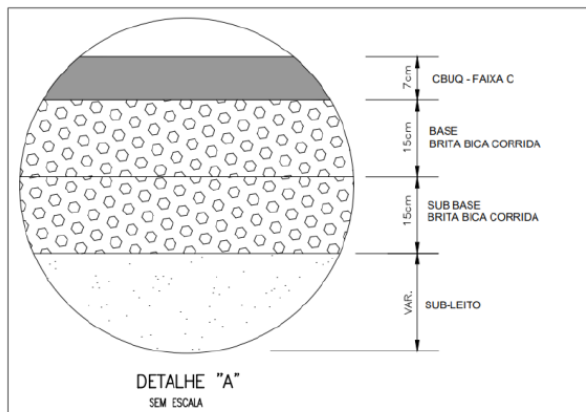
Detalhamento da Seção Tipo Pavimentação Avenida Rosalvo Santos
